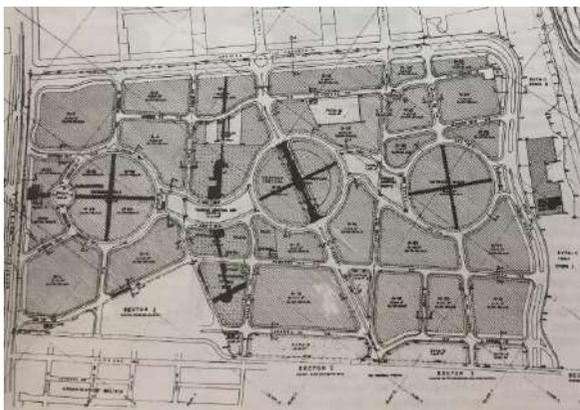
Ciudadela Colsubsidio. Planta general del proyecto
